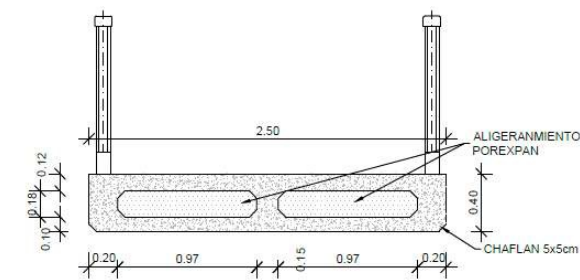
Sección transversal en zona de rampa. Pasarela P-3
